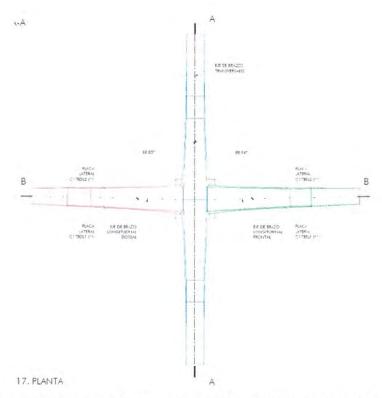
Ejemplo de planos para fabricación de columnas de la Calzada Peatonal
